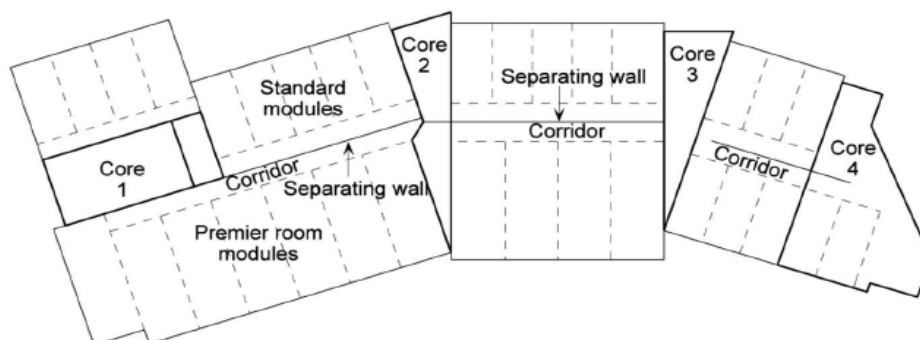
Disposición de núcleo en planta de una construcción de 12 plantas. Fuente: (Lawson et al. 2012).
